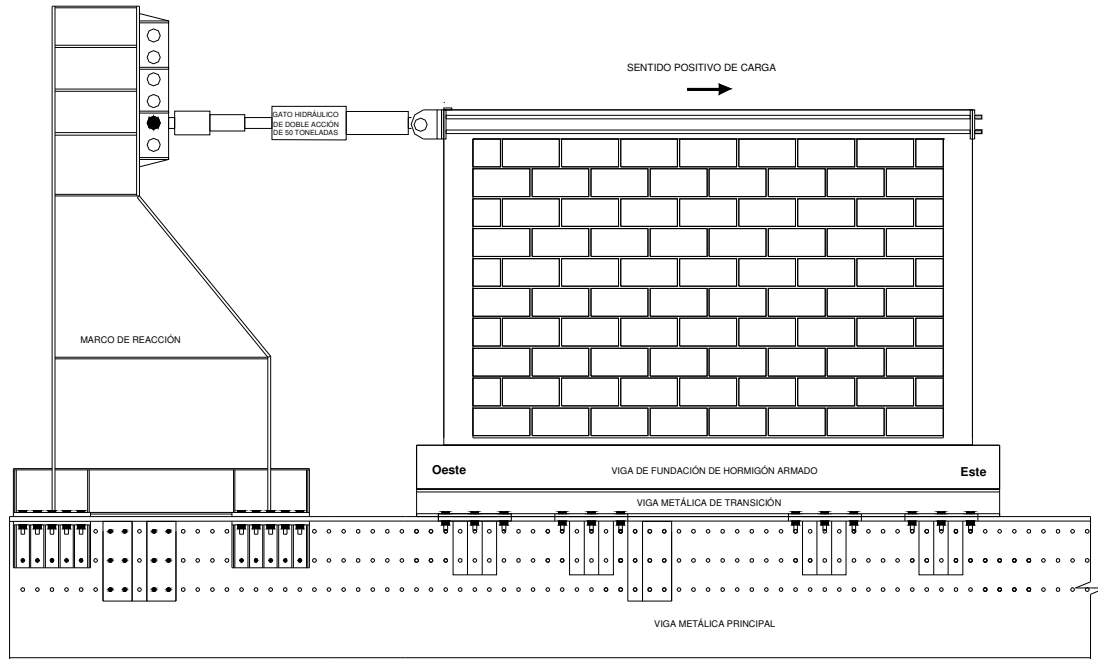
Ensayo de un muro de albañilería confinada sin dispositivo de aplicación de carga vertical (Ogaz, 2004)
